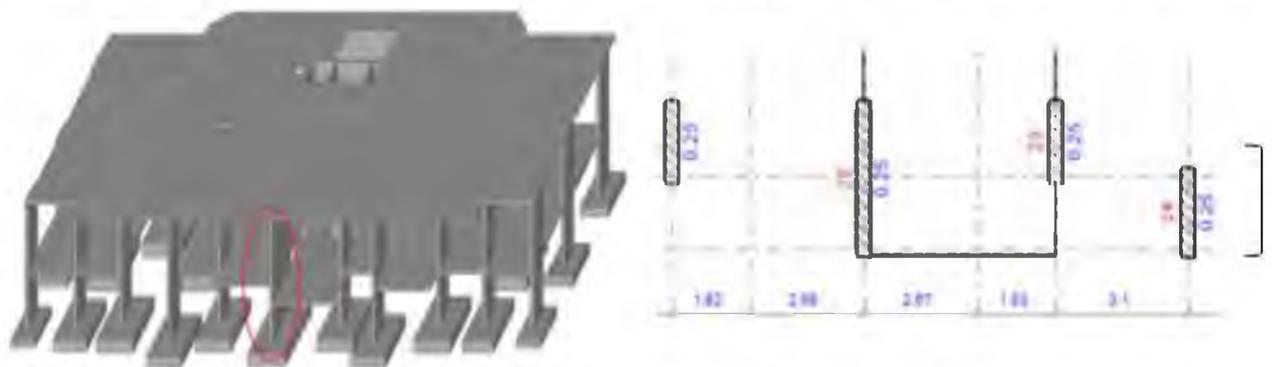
Найбільш напружений пілон каркасу будівлі
